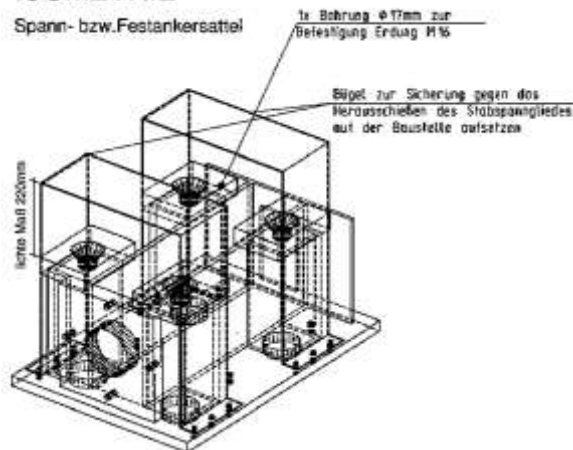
Endverankerung (Detail I): Ausführung, Detailzeichnung und Isometrie
